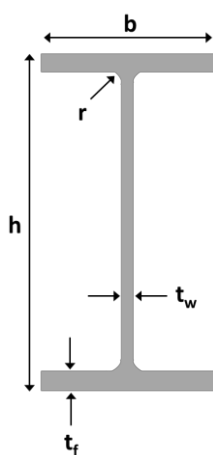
Page de paramétrage de l'outil poutrelle sur www.save-construction.com
